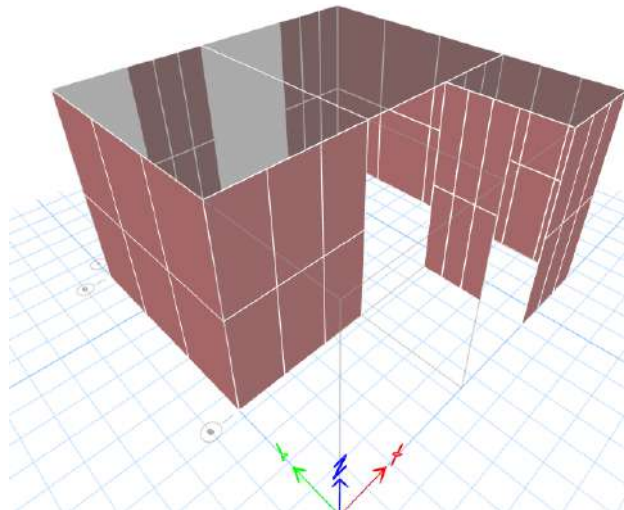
Vista en planta del modelamiento de la vivienda 13
